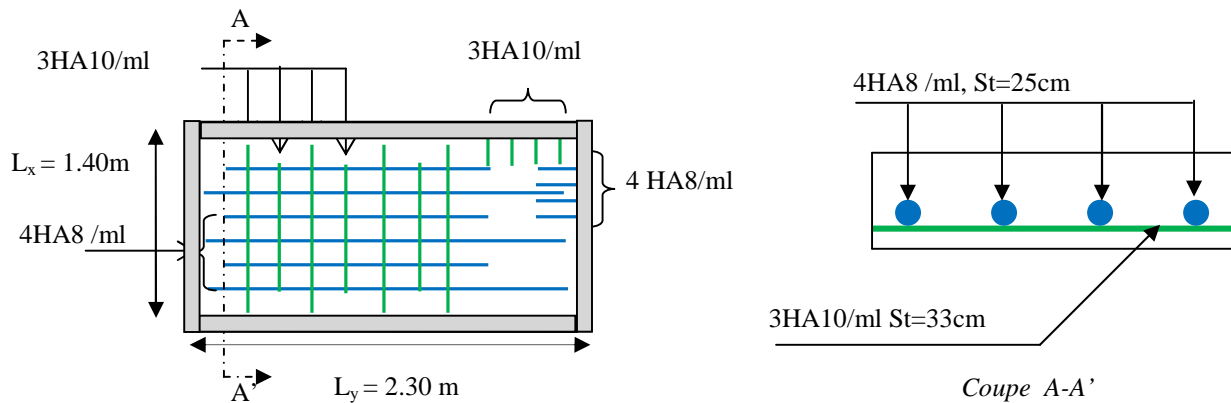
Schéma de ferrailage Dalle pleine sur quatre appuis.
